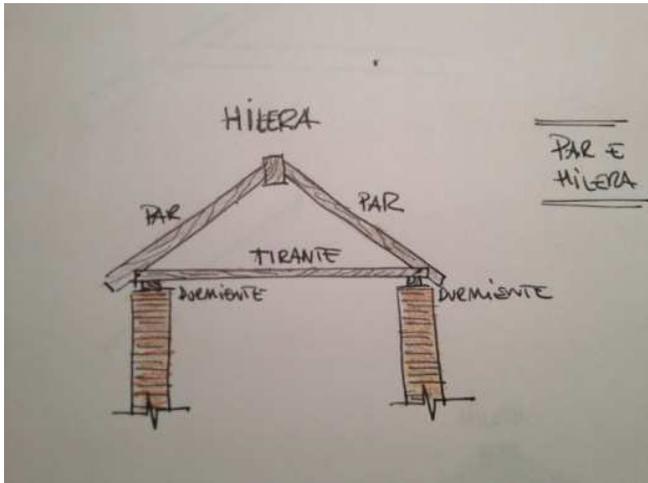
Detalle de cubierta de par e hilera. (MARÍN)
